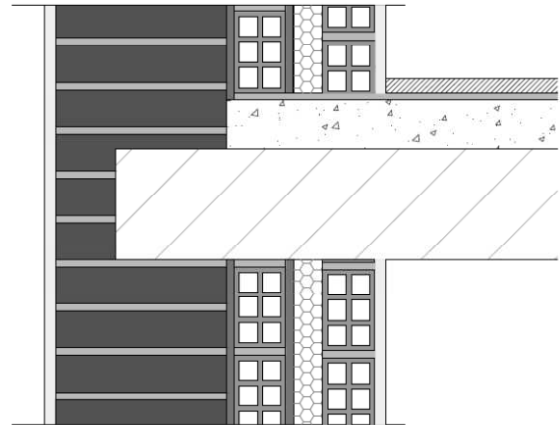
Fachada-Forjado (por vigueta). Zona oeste. Estado rehabilitado.
